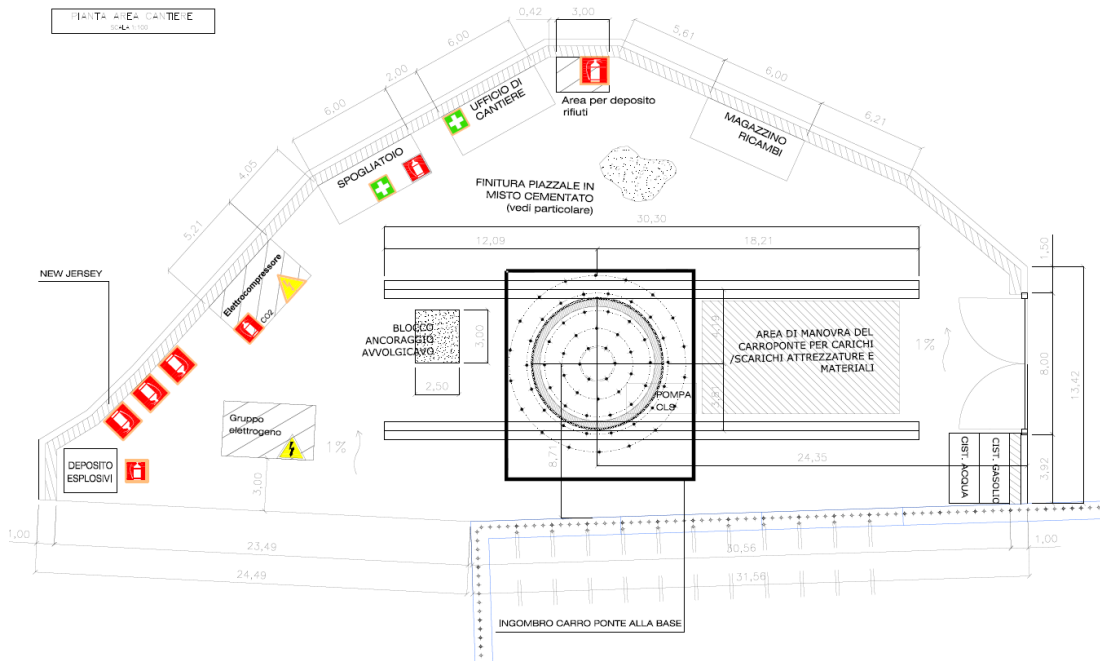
Cantiere pozzo: fase 2 – alesatura pozzo con scavo dall'alto
